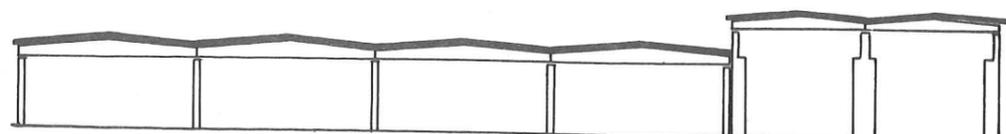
Vierschiffiges Gebäude mit und ohne Hängetransport nach TSR 64-2 mit zweigeschossigem Anbau mit Brückenkran nach TSR 64-3
